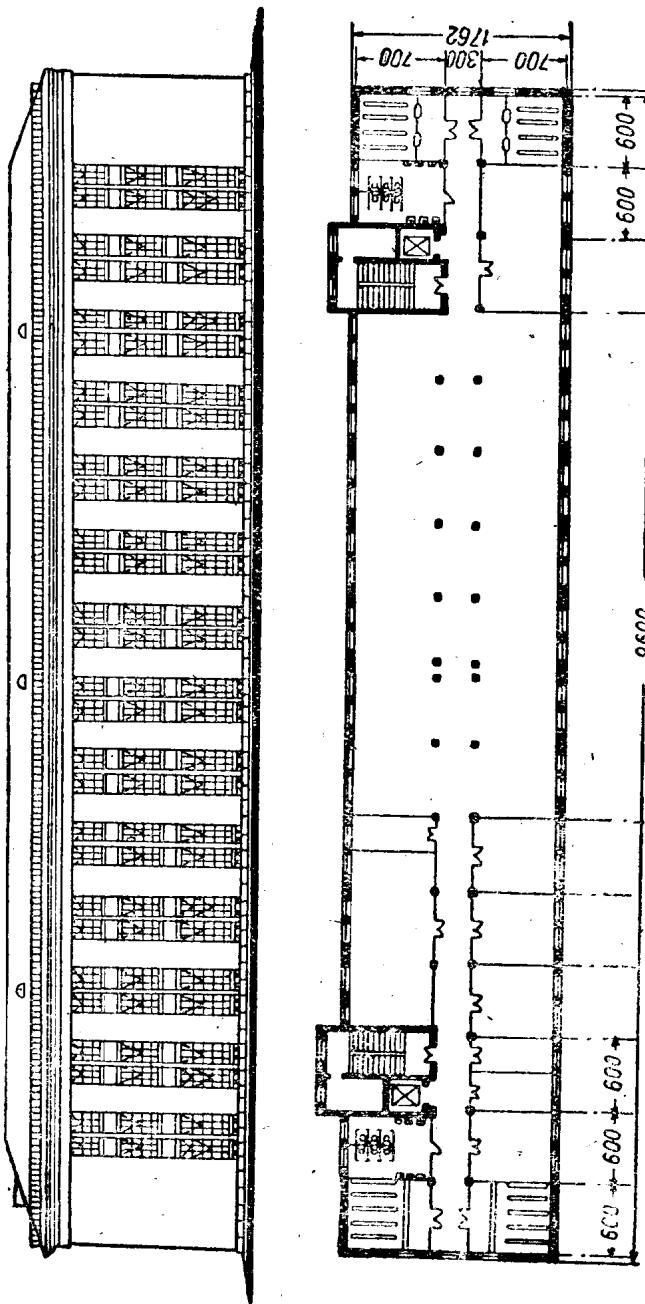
由定型单元组合成的 3 层生产厂房的立面图和平面图
